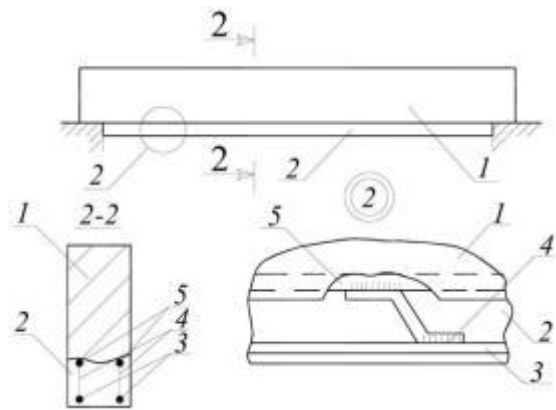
Нарощування перерізу балок у розтягнутій зоні при значному збільшенні їхньої несучої здатності: 1 – балка, яка посилюється; 2 – залізобетонне нарощування; 3 – поздовжня арматура посилення; 4 – арматурні відгини; 5 – оголена арматура балки (ділянки із кроком через 1.0 м)
